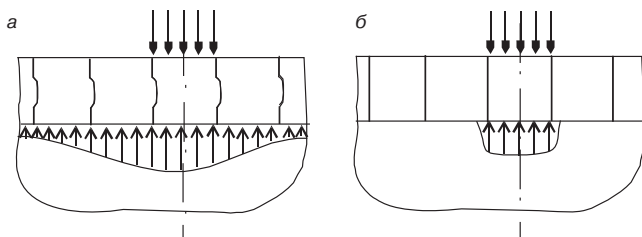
Эпюры нормальных сжимающих напряжений под слоями из бетонных блоков со шпунтовым соединением (а) и без соединения (б)
